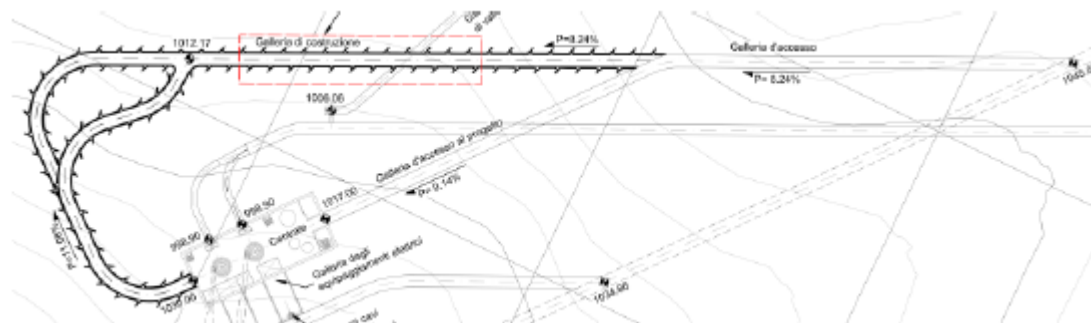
Galleria di costruzione della nuova centrale in caverna - pianta
